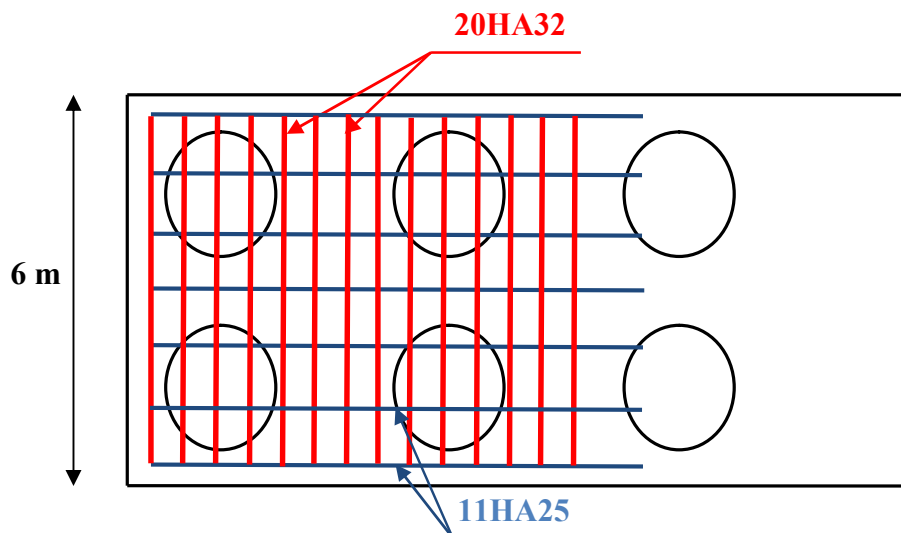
Le ferrailage de la semelle (nappe inférieure).
